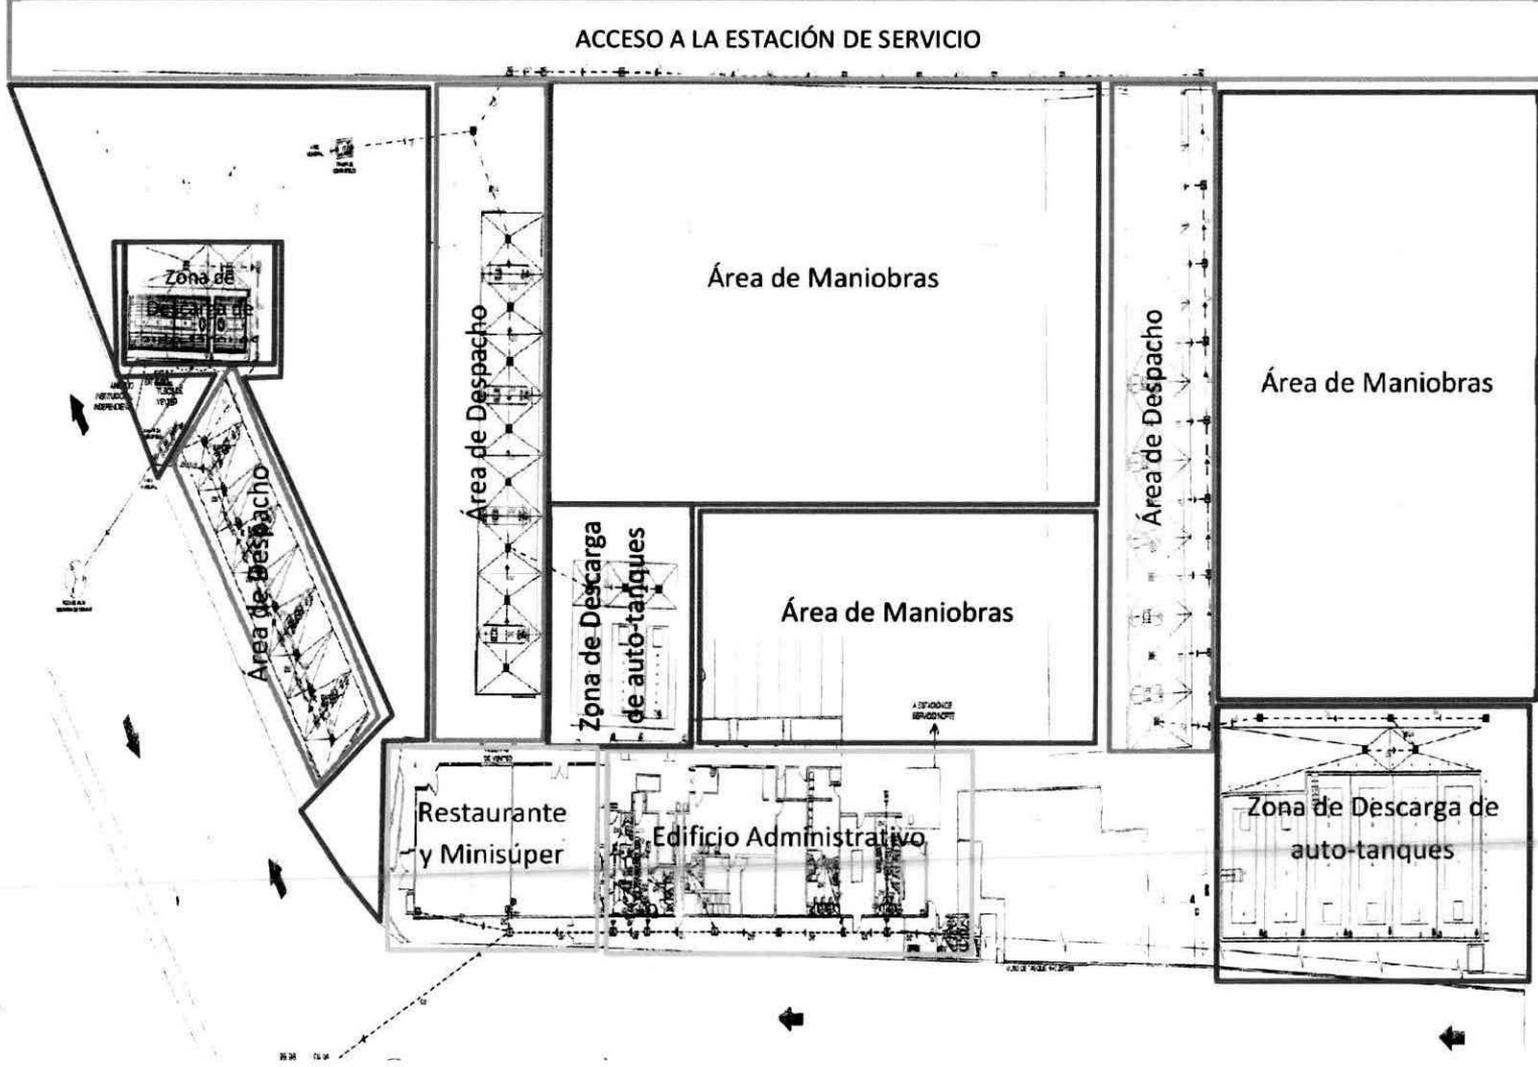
Plano de conjunto de la Estación de Servicio.
